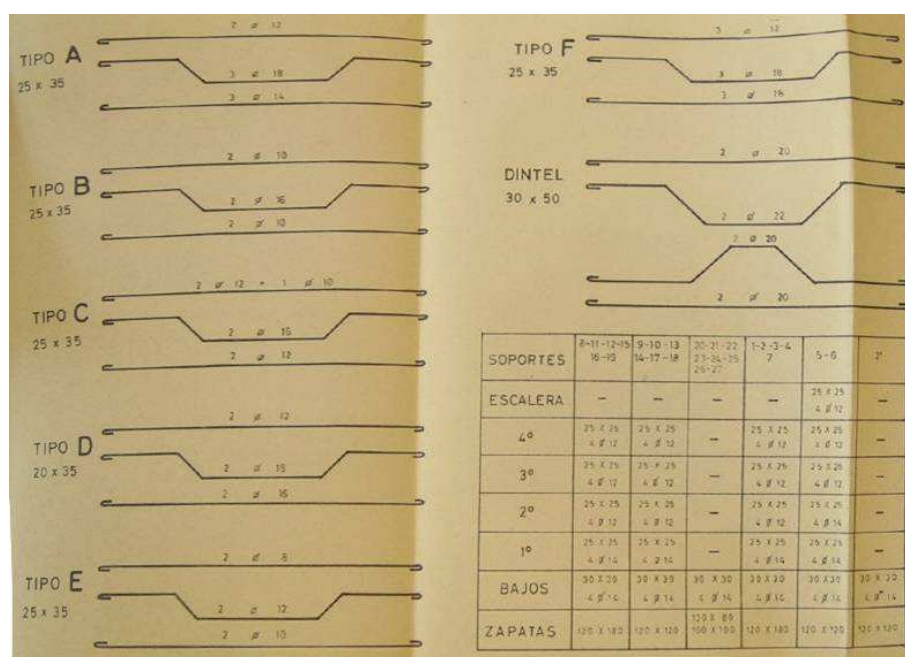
Plano de estructura, Edificio ficha 91C.019, 1966.
